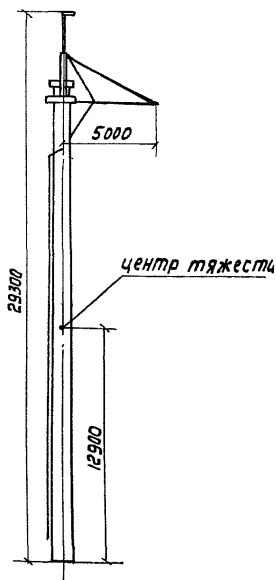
Монтажные элементы раздельной установки стоек опор
